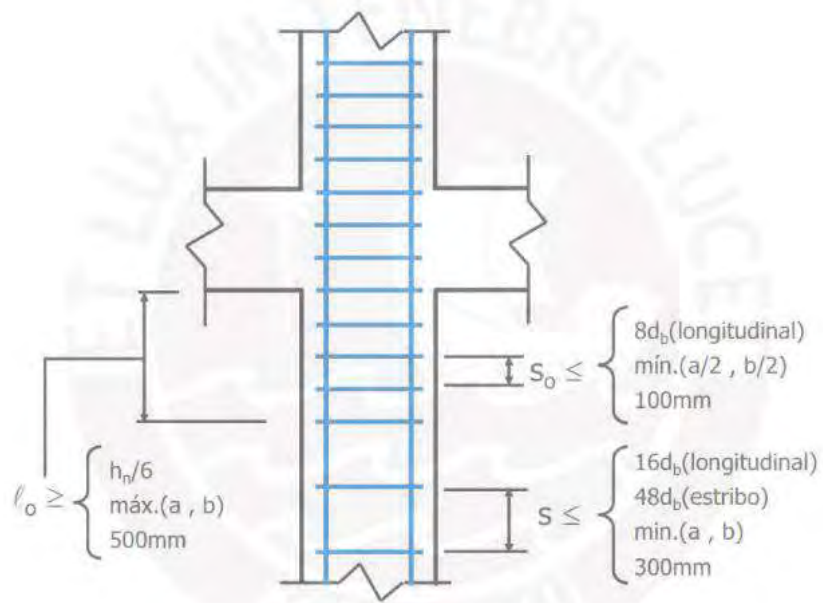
Espaciamiento de estribos para el diseño por cortante en columnas
